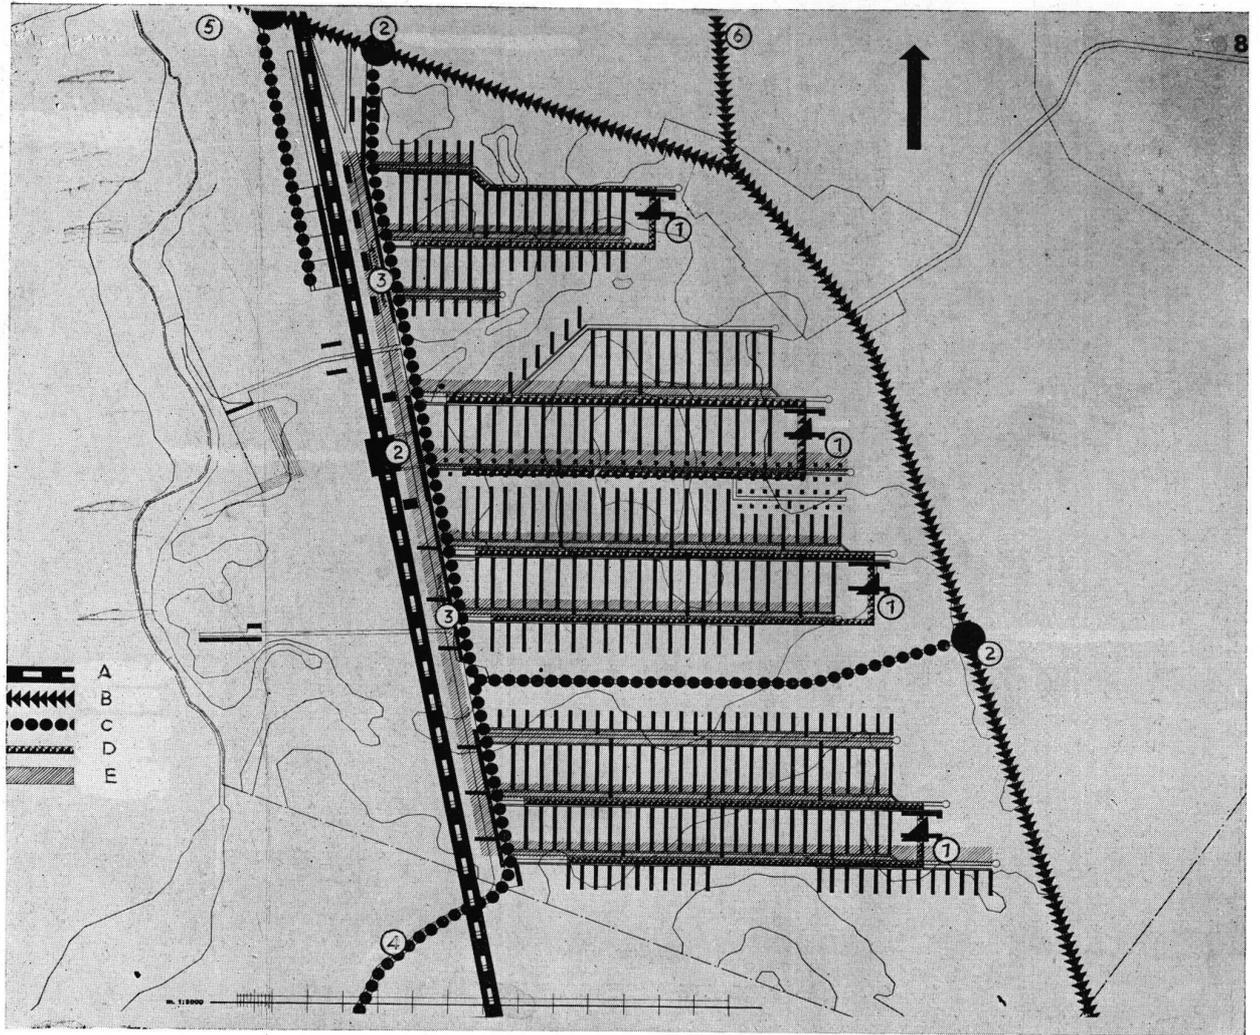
PLANO DE TRAFICO. TERRENO I
